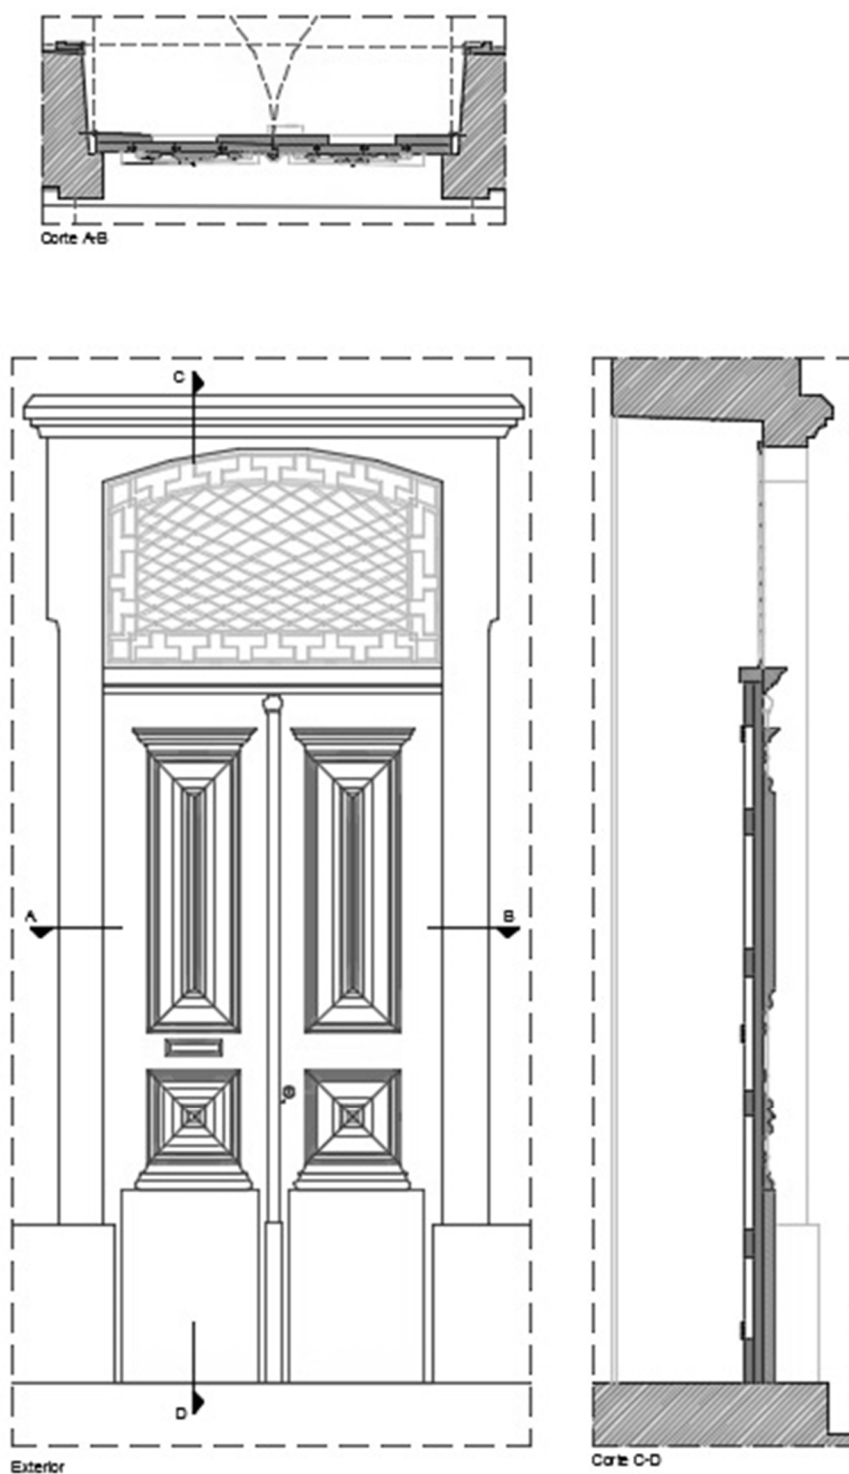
Pormenor da caixilharia exterior (s/escala) – (Autor)
